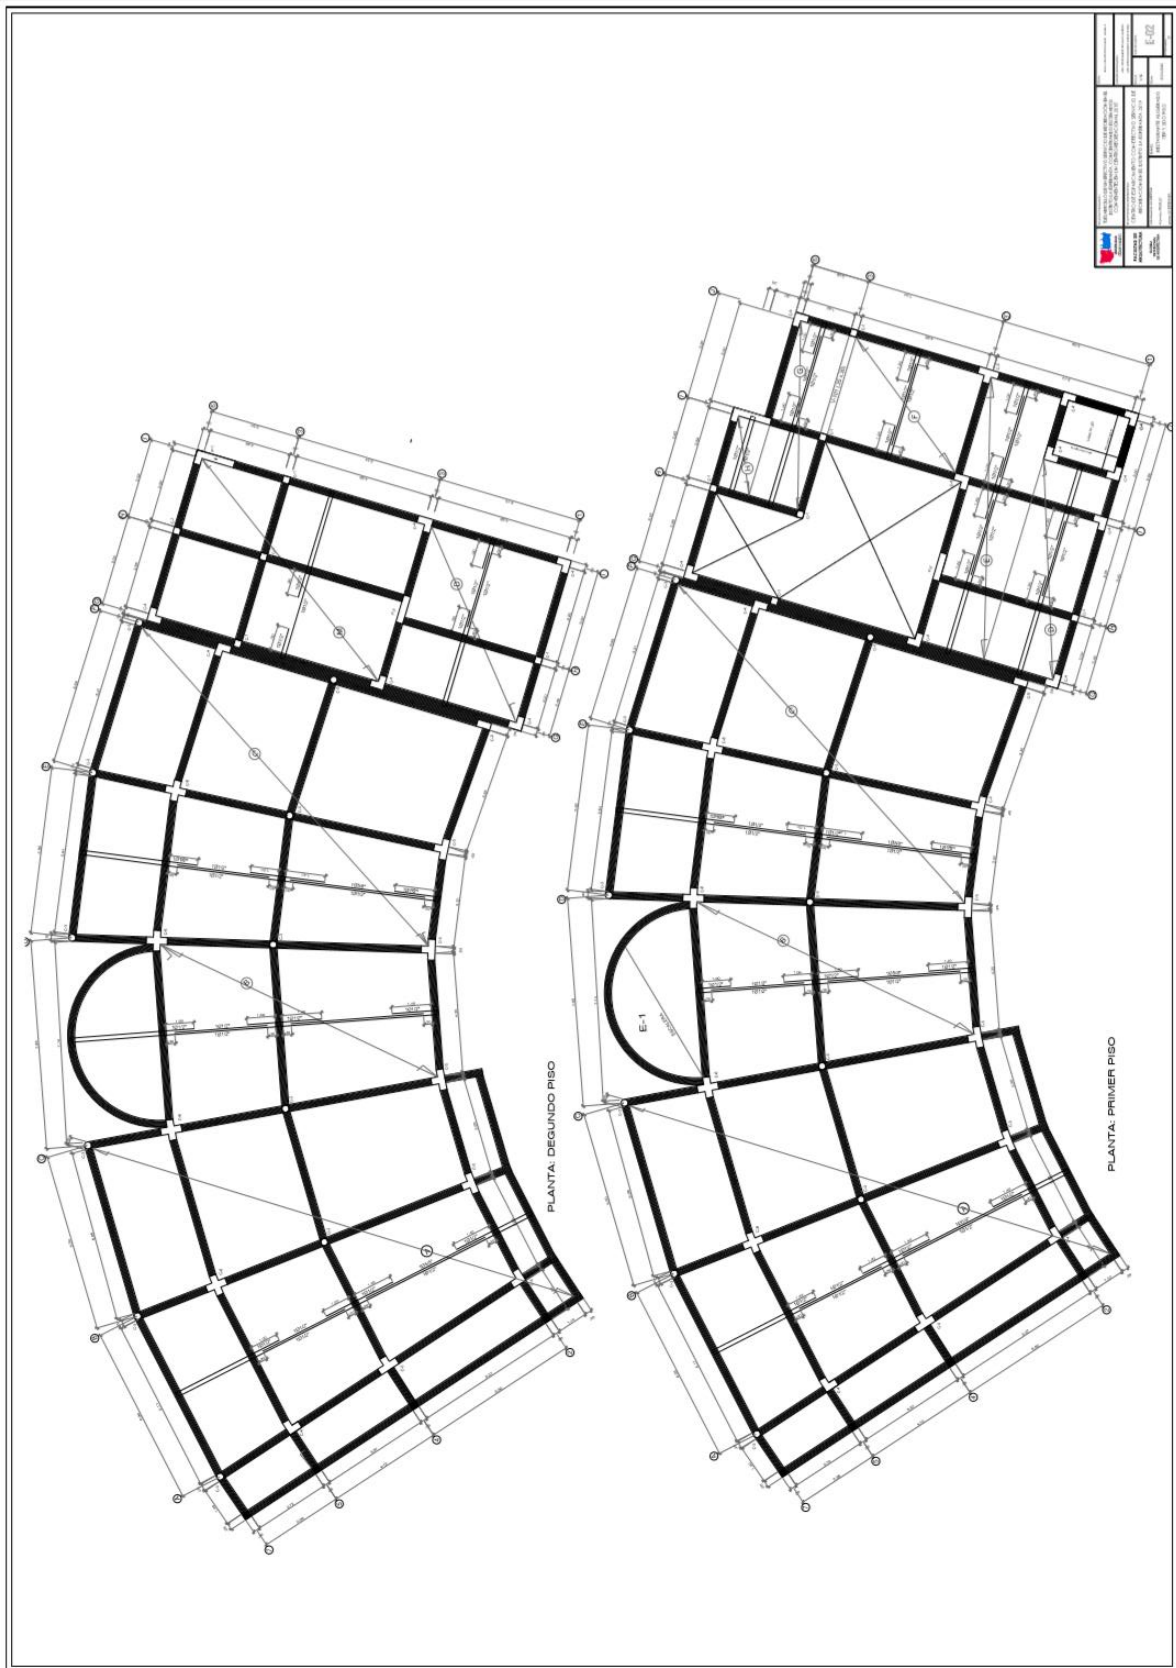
Plano de Restaurante - Aligerado 1er y 2do piso. Elaboración propia.
